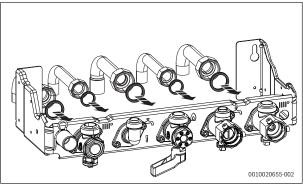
Montage des tubes avec les joints sur la plaque de montage pour le raccordement
